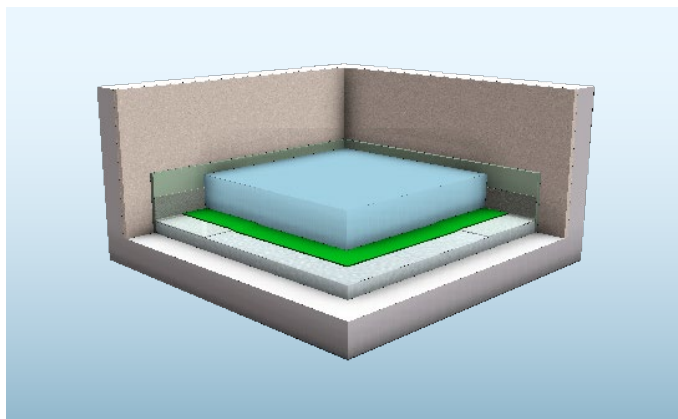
Fußbodenaufbau Estrich auf Dämmschicht
